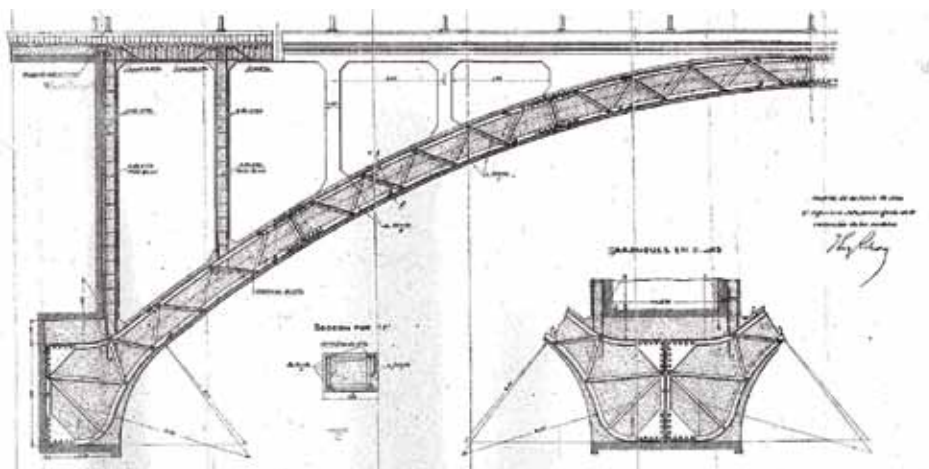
Plano de puente arco de 25 m de luz rebajado al 1/4 de la colección de modelos de puentes de hormigón armado de J. E. Ribera
